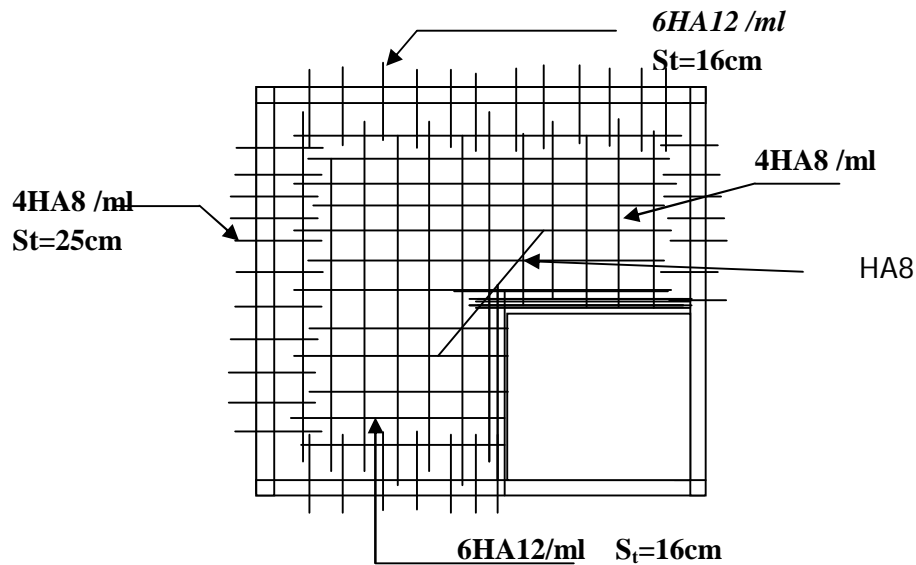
schéma de ferrailage de la dalle sur 4 appuis.
